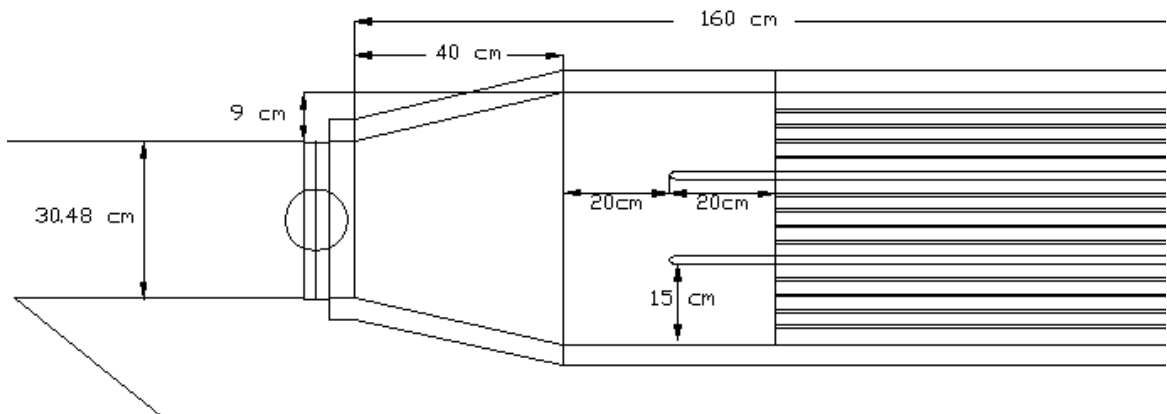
canal de rejás y canal de transición. Vista en Planta
